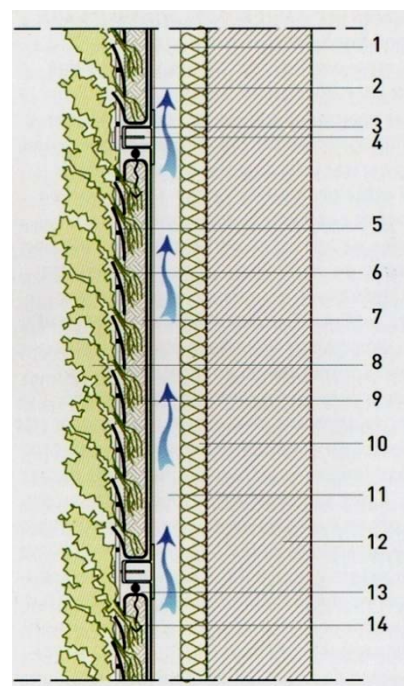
Corte explicativo de uma Parede Viva tipo Muro Cortina:
